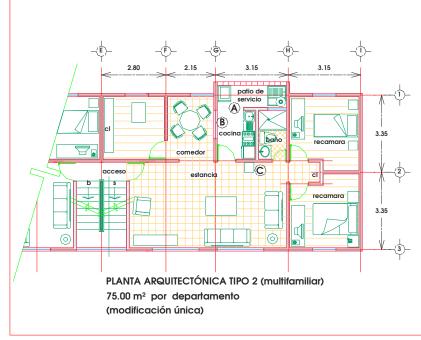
Planta arquitectónica tipo II modificaciones únicas
